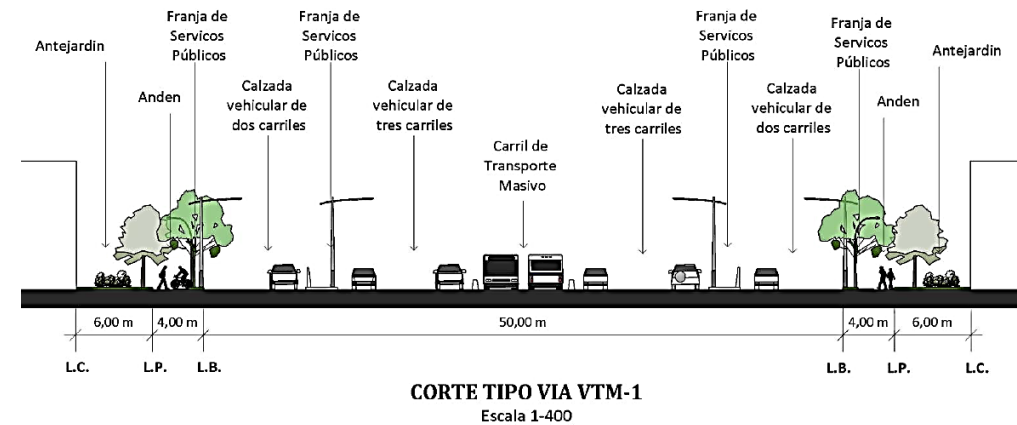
Corte del Perfil Proyectado Ampliación Carrera 38. Fuente Formulación Plan de Ordenamiento Territorial 2012 – 2032
